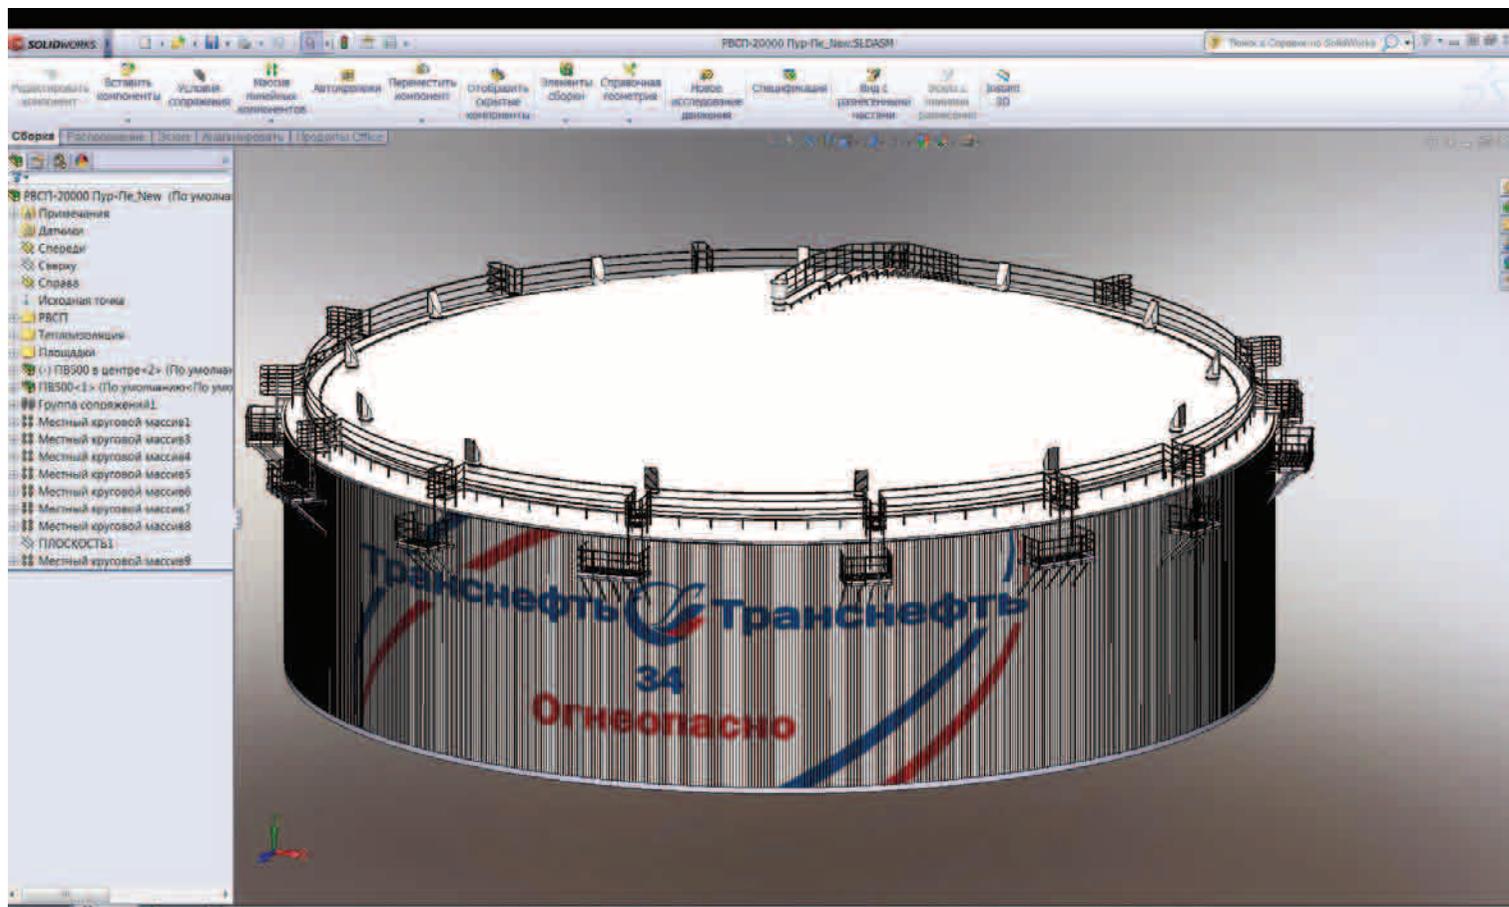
3D-модель нефтяного резервуара, разработанная в SolidWorks (сборка)
